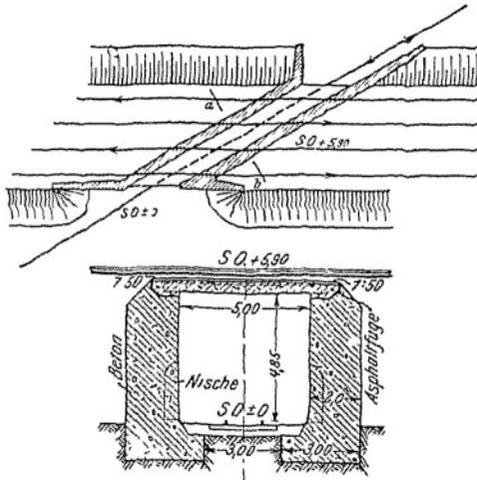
Tunnelartige Unterführung. (Lageplan und Querschnitt a—b.)
